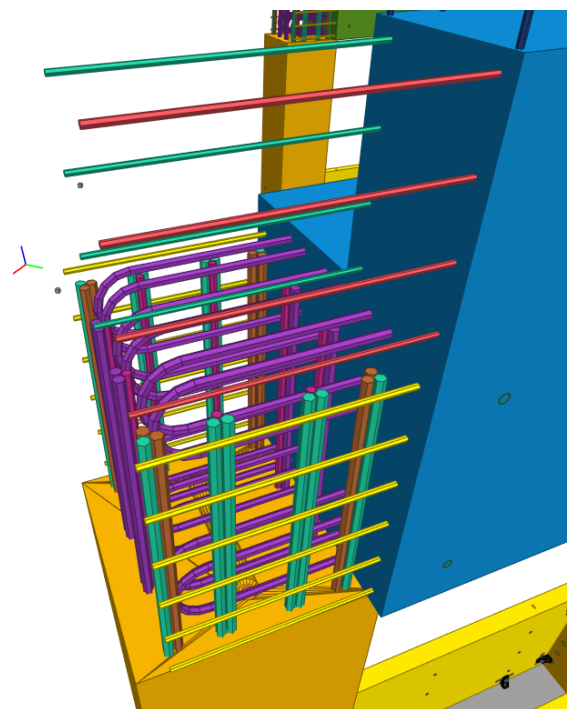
Vista del modelo en el encuentro de los pilares prefabricados con los dinteles prefabricados
